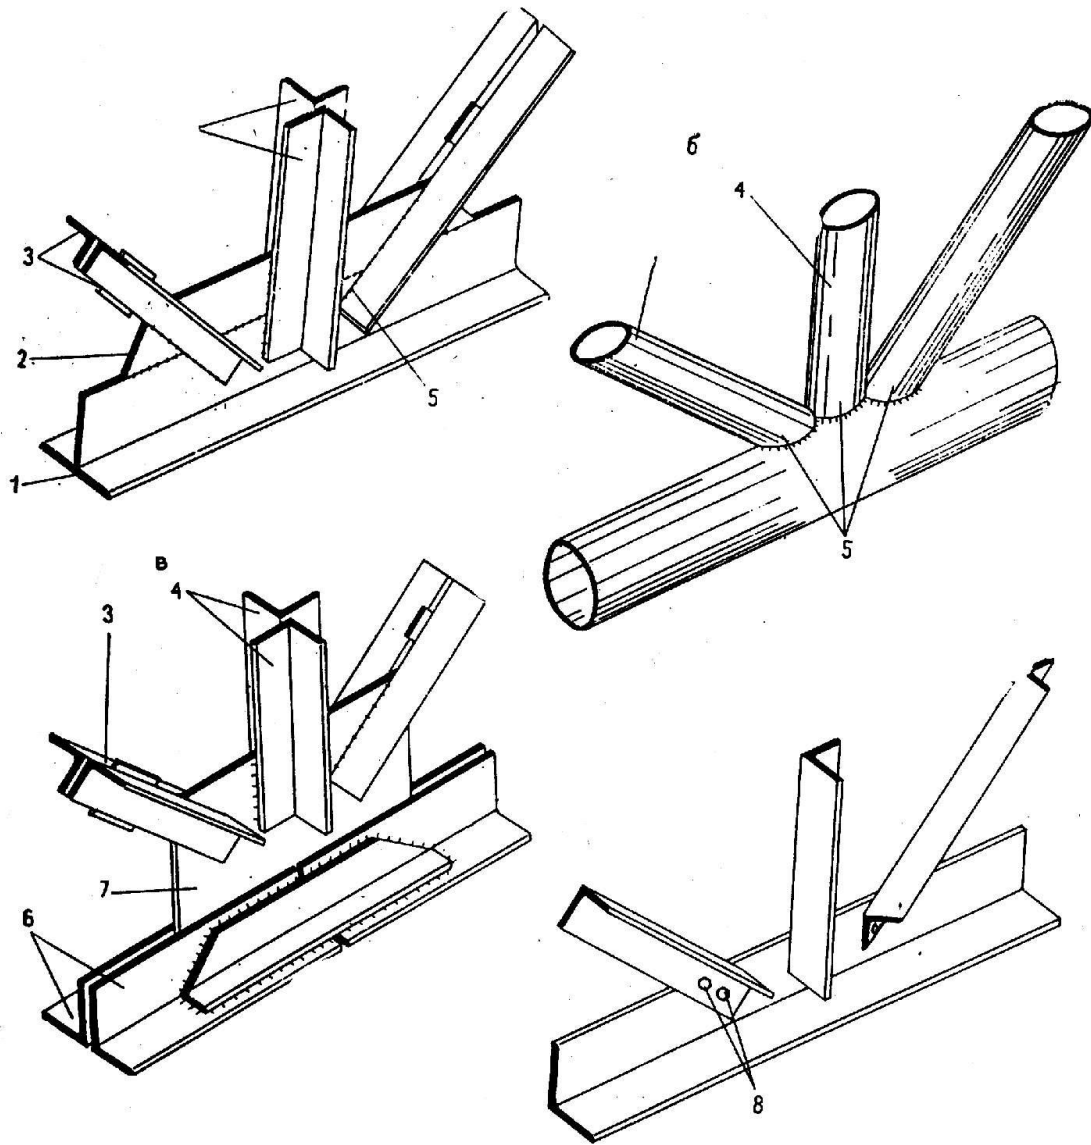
Узлы нижнего пояса стальных ферм
